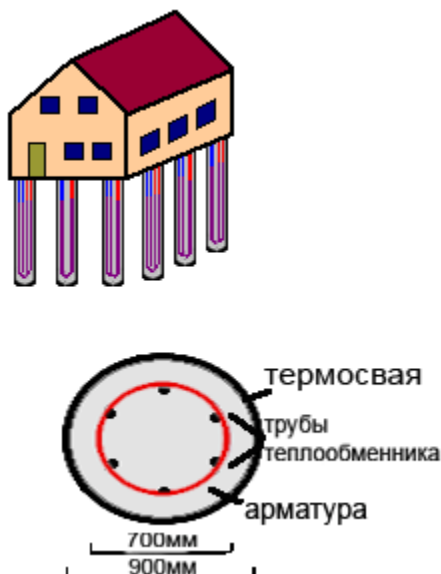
Схема грунтовых теплообменников, замоноличенных в фундаментные сваи – термосваи, и поперечное сечение термосваи
